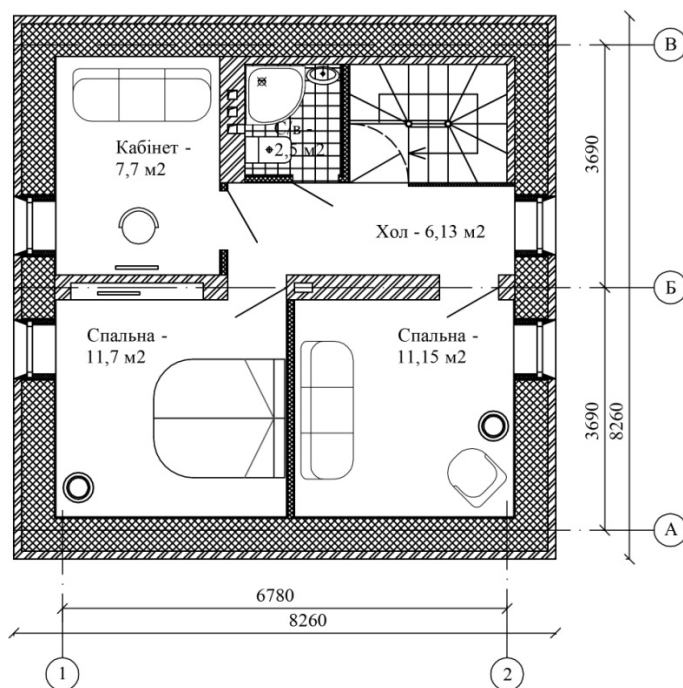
Екологічна будівля «потрійний нуль». План мансардного поверху
